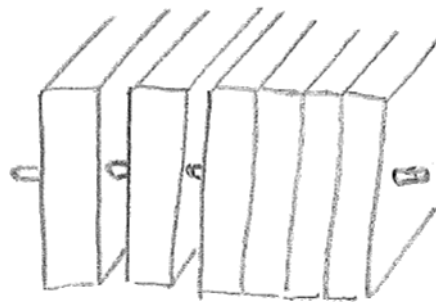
Schema Brettstapel aus Holzlamellen und Holzdübel
